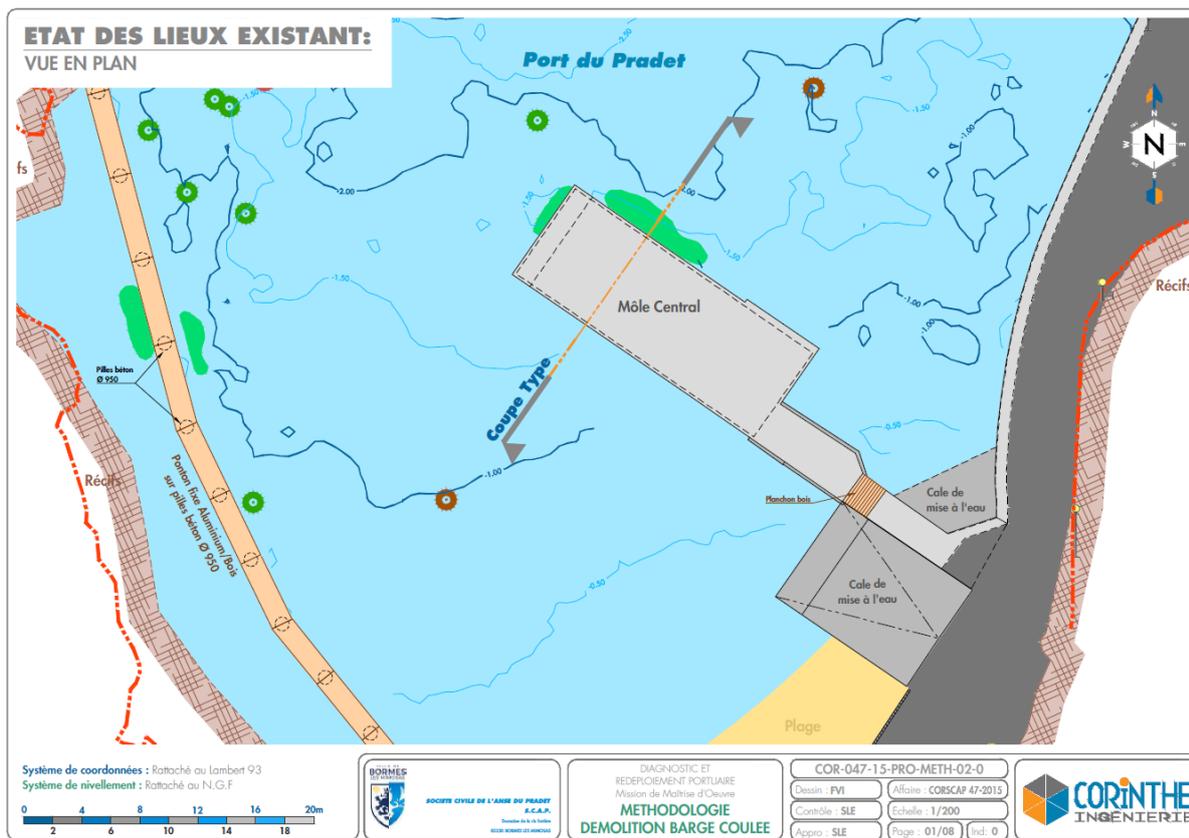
État des lieux existant – Vue en plan (figure 134 dossier LEMA)
